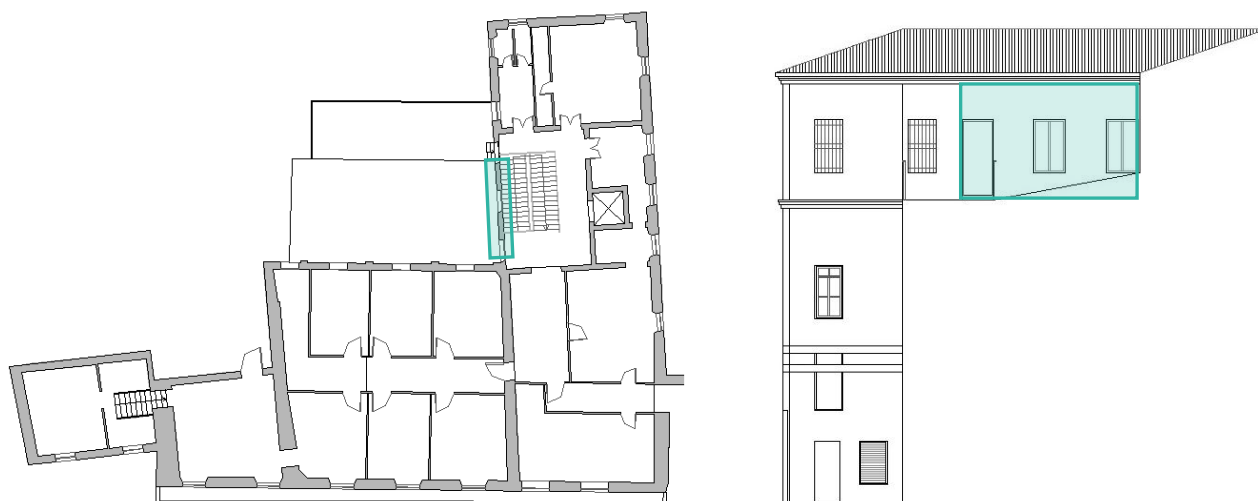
Individuazione macroelemento, pianta e prospetto
